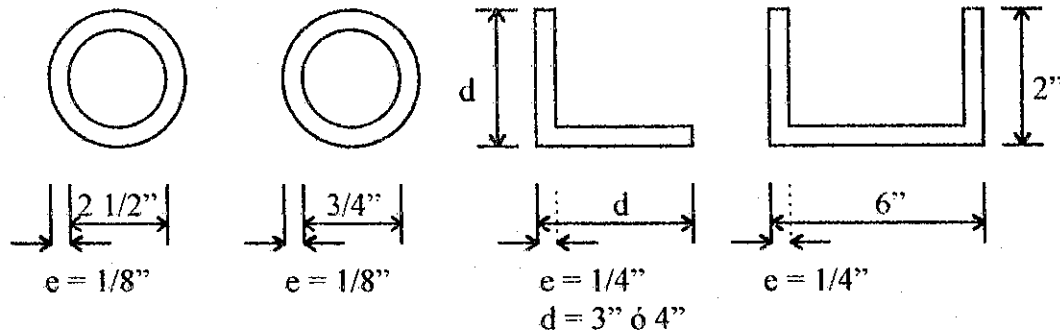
Perfiles más utilizados en la construcción de subestaciones
